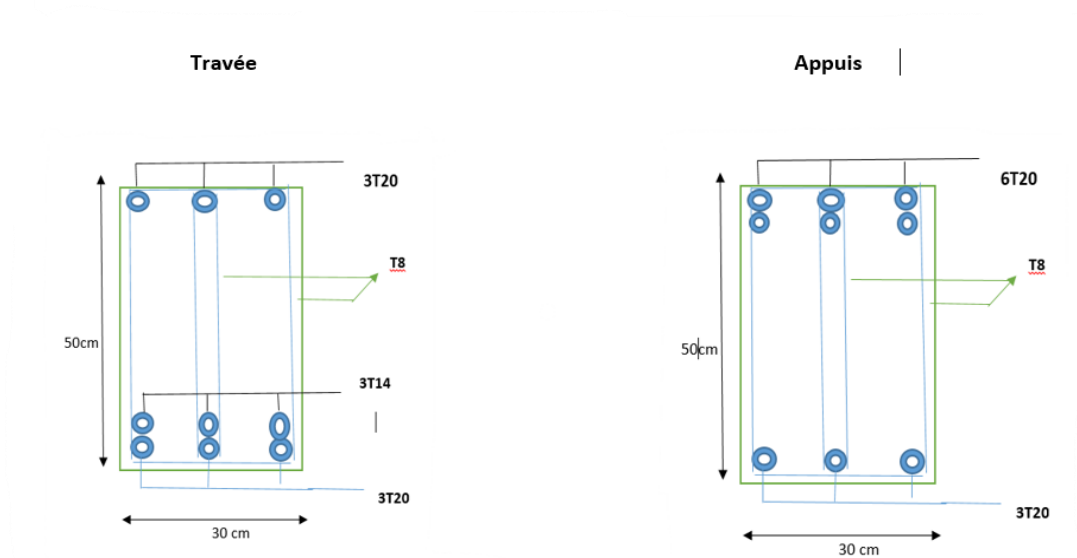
Schéma de ferrailage des poutres porteuses.
